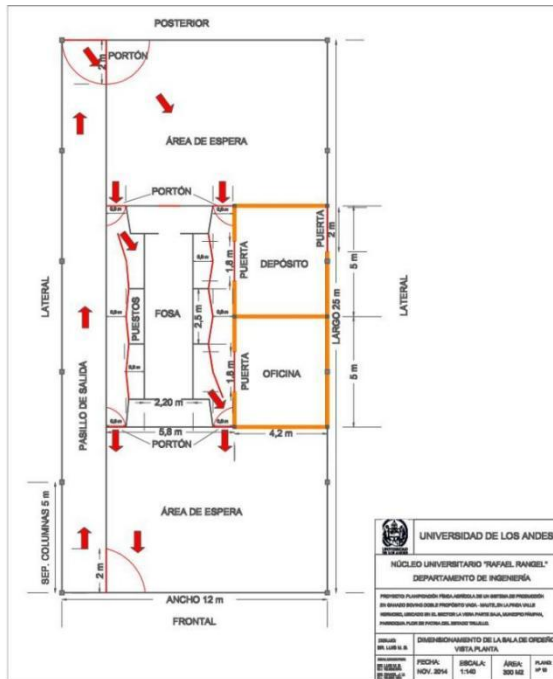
Dimensionamiento de la sala de ordeño – vista planta.
